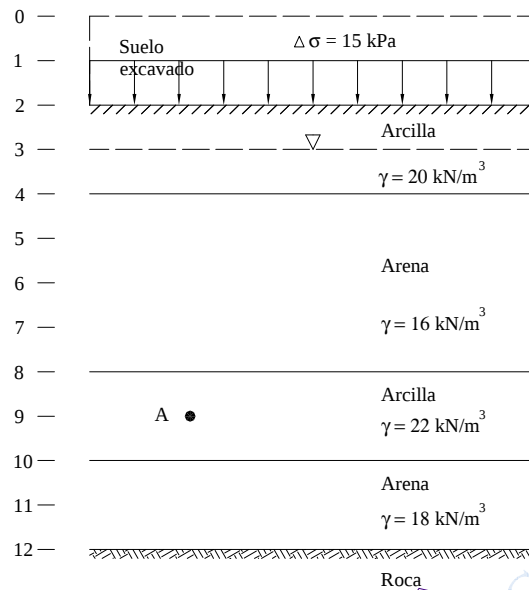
Perfil del suelo inmediatamente después de la excavación (corto plazo).
